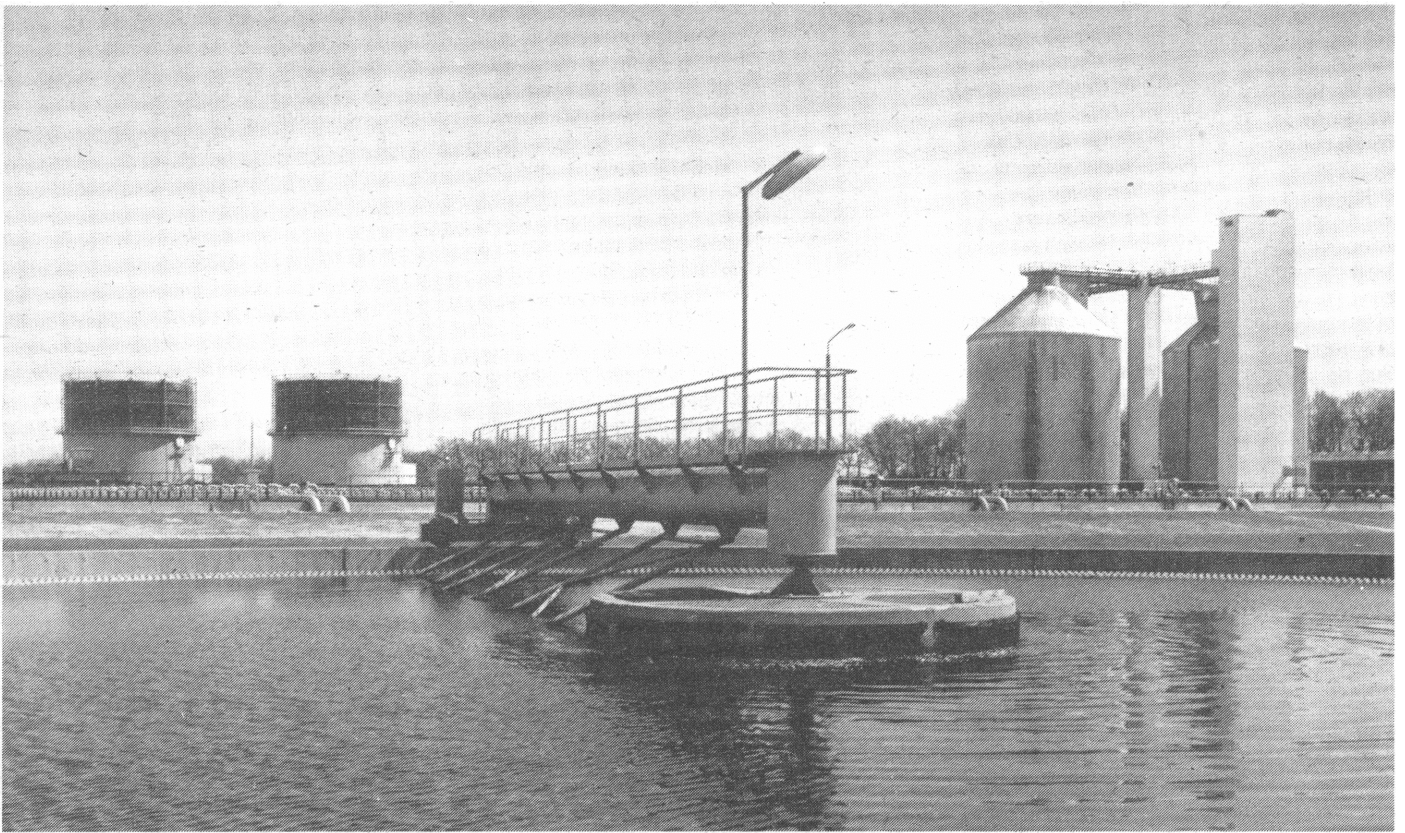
Kläranlage Münchehofe im Bereich des VEB WAB Berlin – Foto: Kraemer
